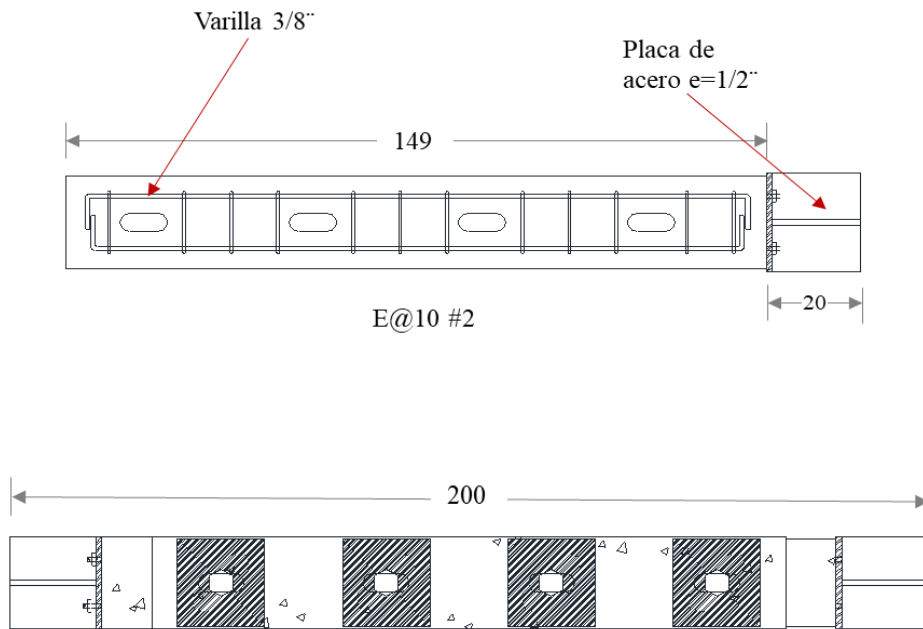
Dimensiones en cm, del prototipo DFC-01.
